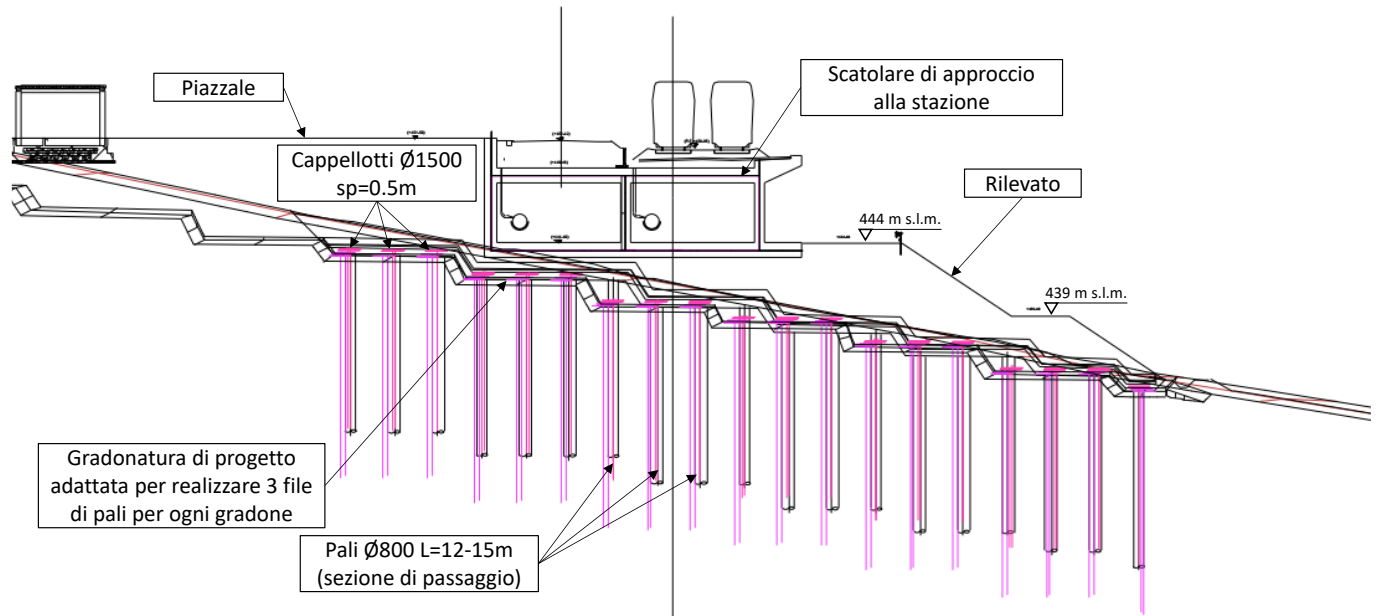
Sezione 16. Sovrapposizione tra sezione di progetto e porzione di geometria implementata nel modello
